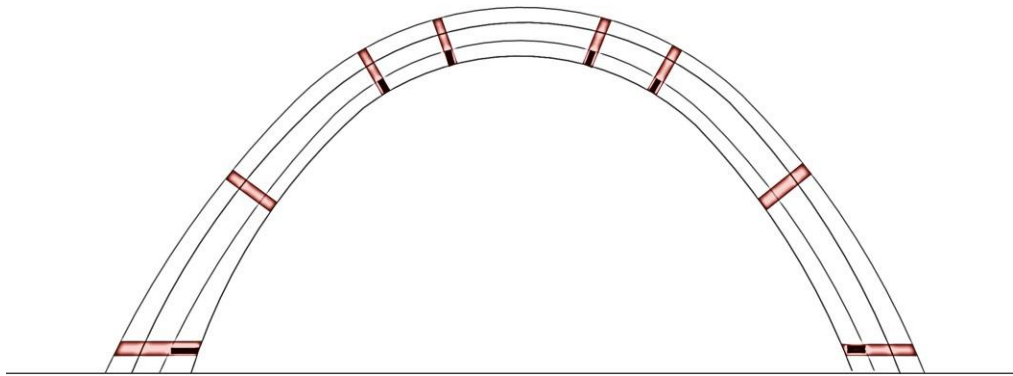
Esquema de estructura externa sosteniendo la estructura interior
